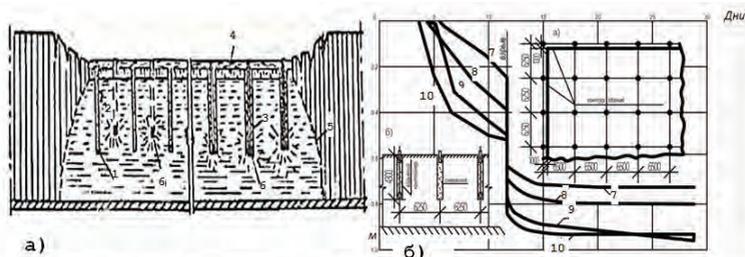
Гидровзрывной способ уплотнения толщи лессового грунта
